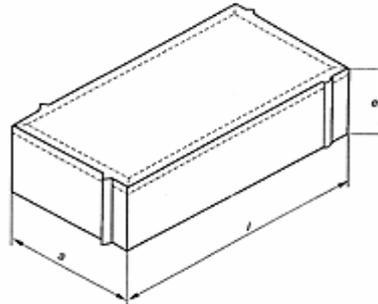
Adoquín con pico espaciador. (FUENTE: www.construmatica.com)
